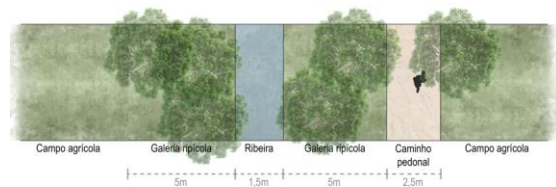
Planta proposta do Caminho da Ribeira da Gândara
